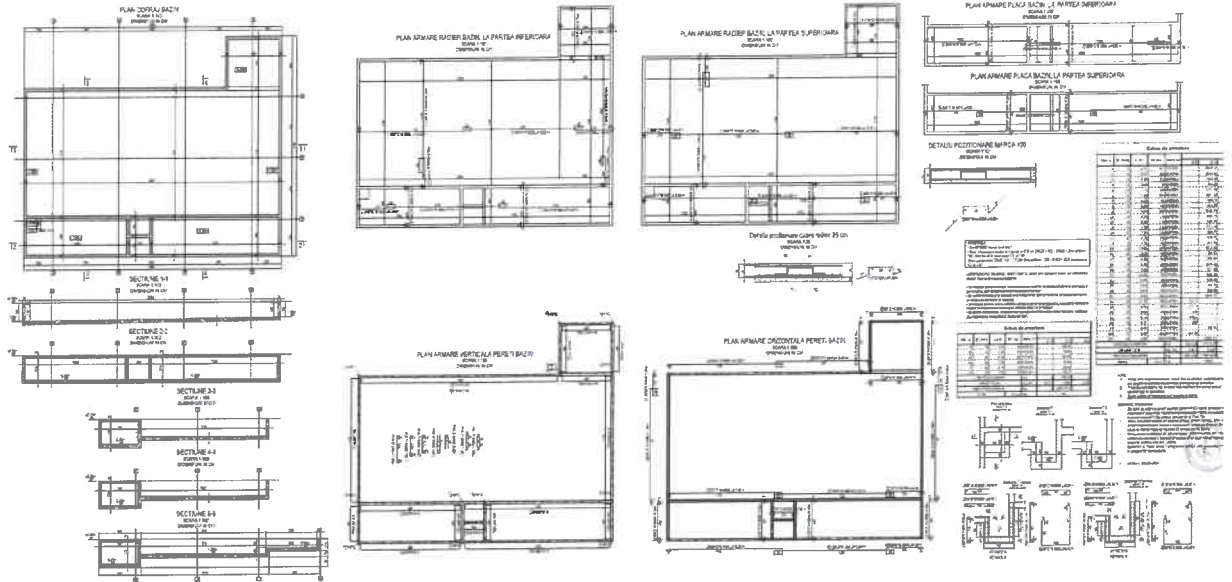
Plan cofraj si armare bazin principal, corp
